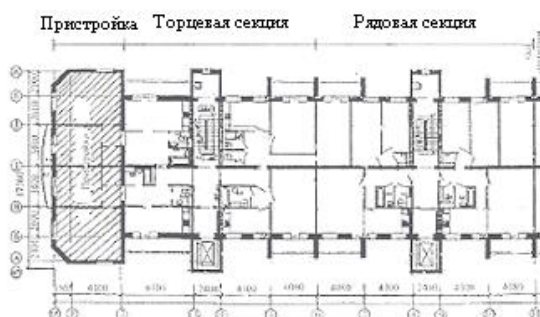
Планировочное решение 2-5-го этажей реконструируемого здания
